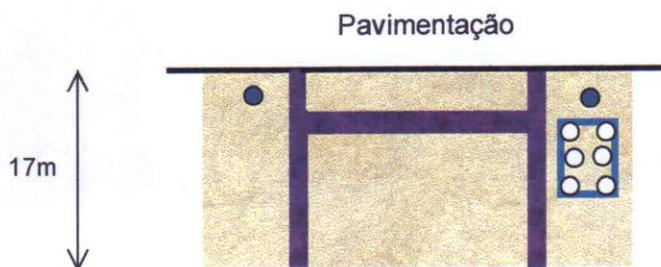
Colocação de conjunto de ponteiros no trecho subterrâneo.
